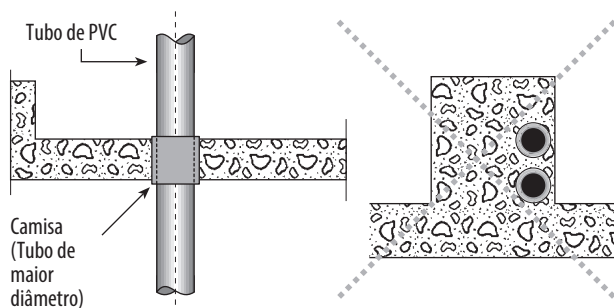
Deficiência de construção, tubos transpondo as estruturas.
